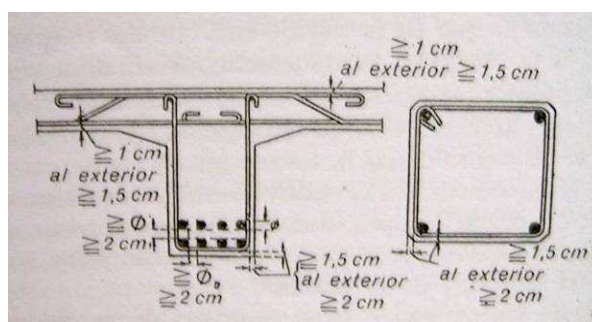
Detalle de recubrimientos y separación según la norma alemana de 1932.
